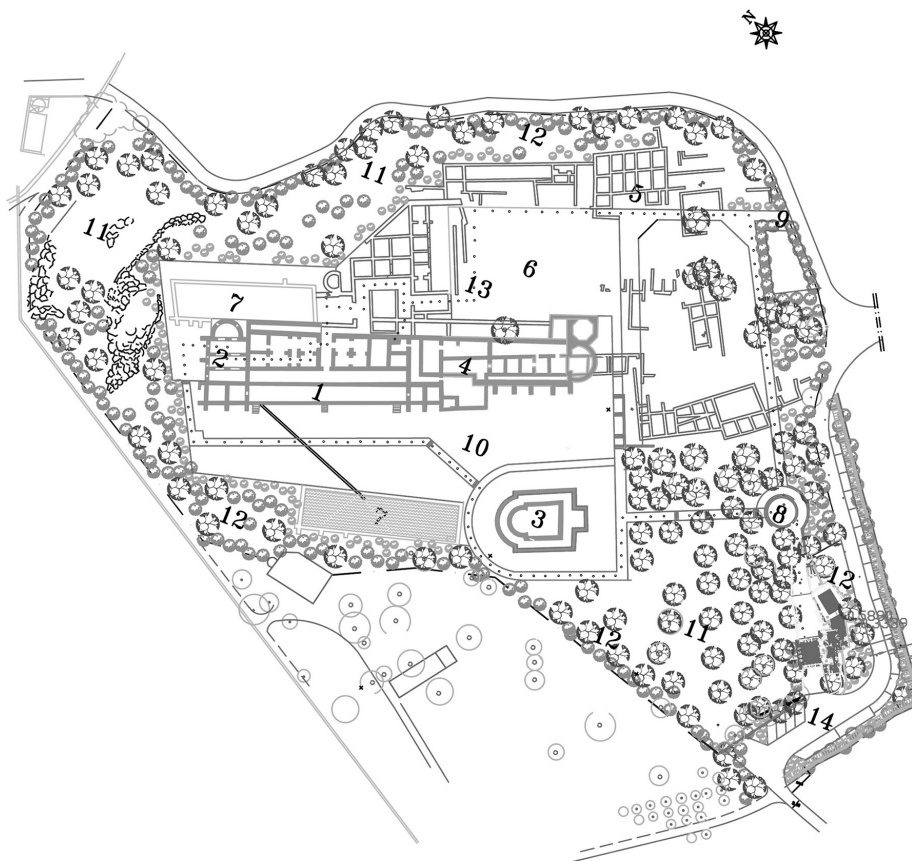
Planta. Arquitecto paisajista F. Caldeira Cabral.
